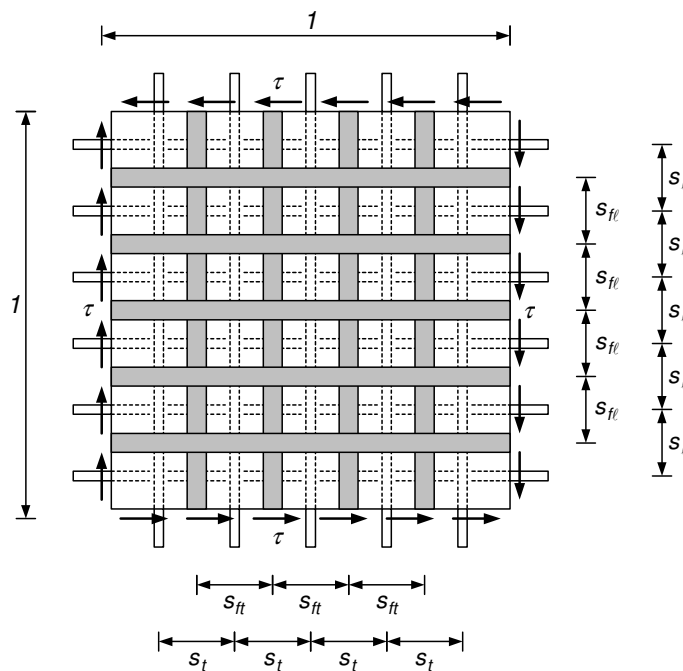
Painel de concreto armado reforçado com CFC.
